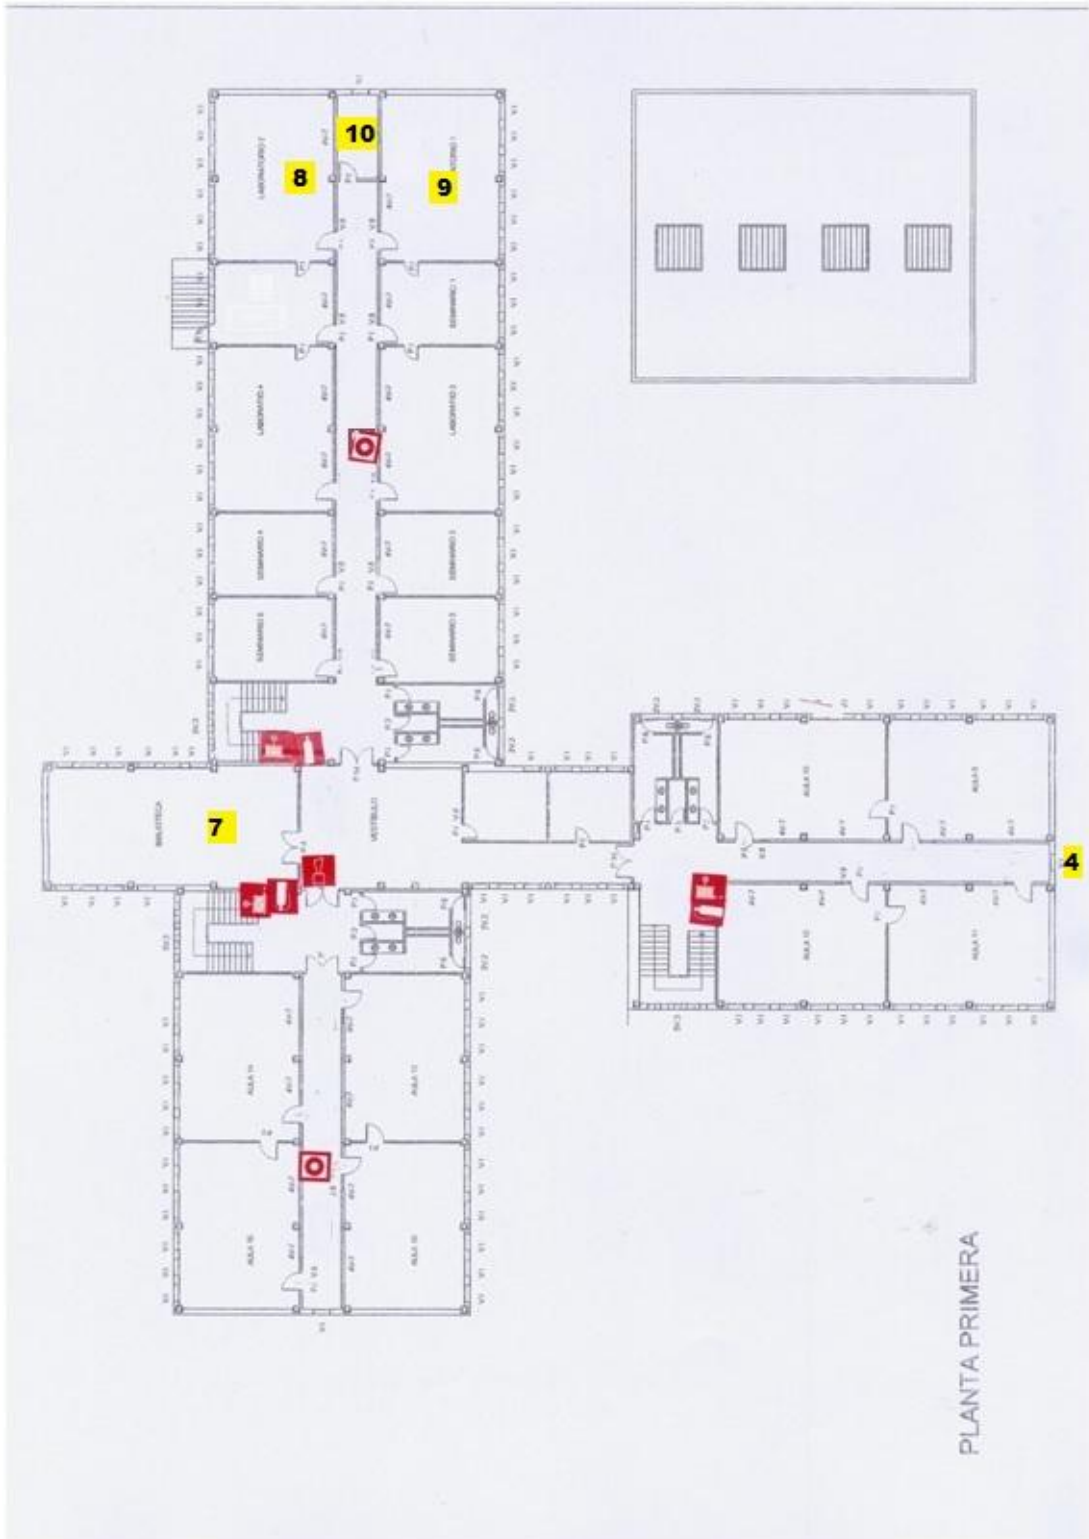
Ubicación elementos e instalaciones de riesgo – Plano planta primera.
